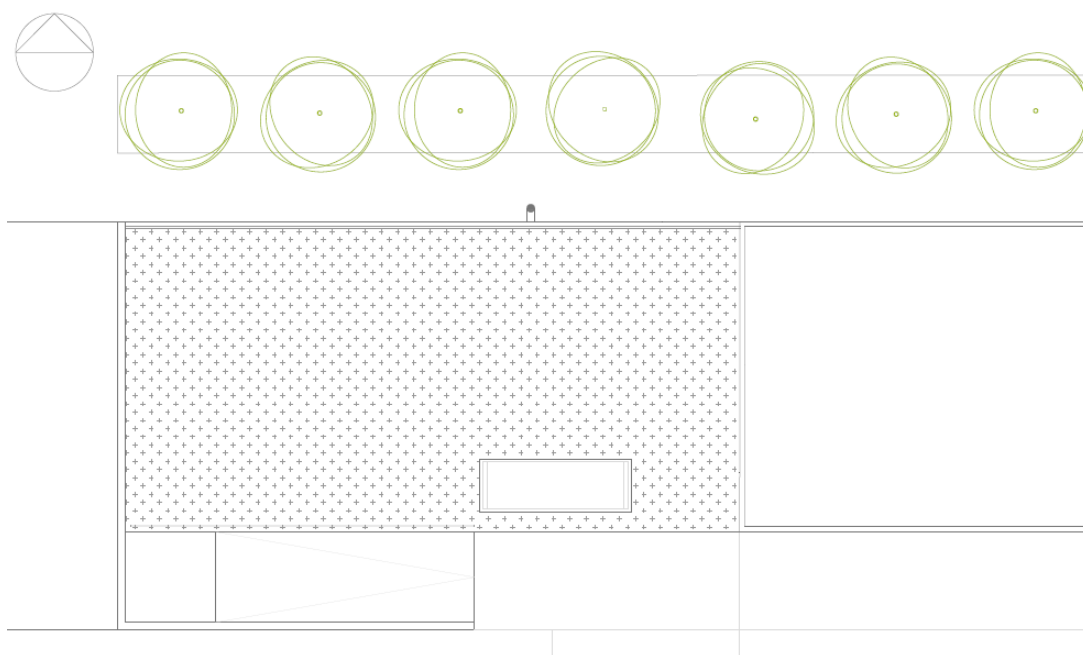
Planta de Cubiertas. Fuente: *Elaboración propia.
